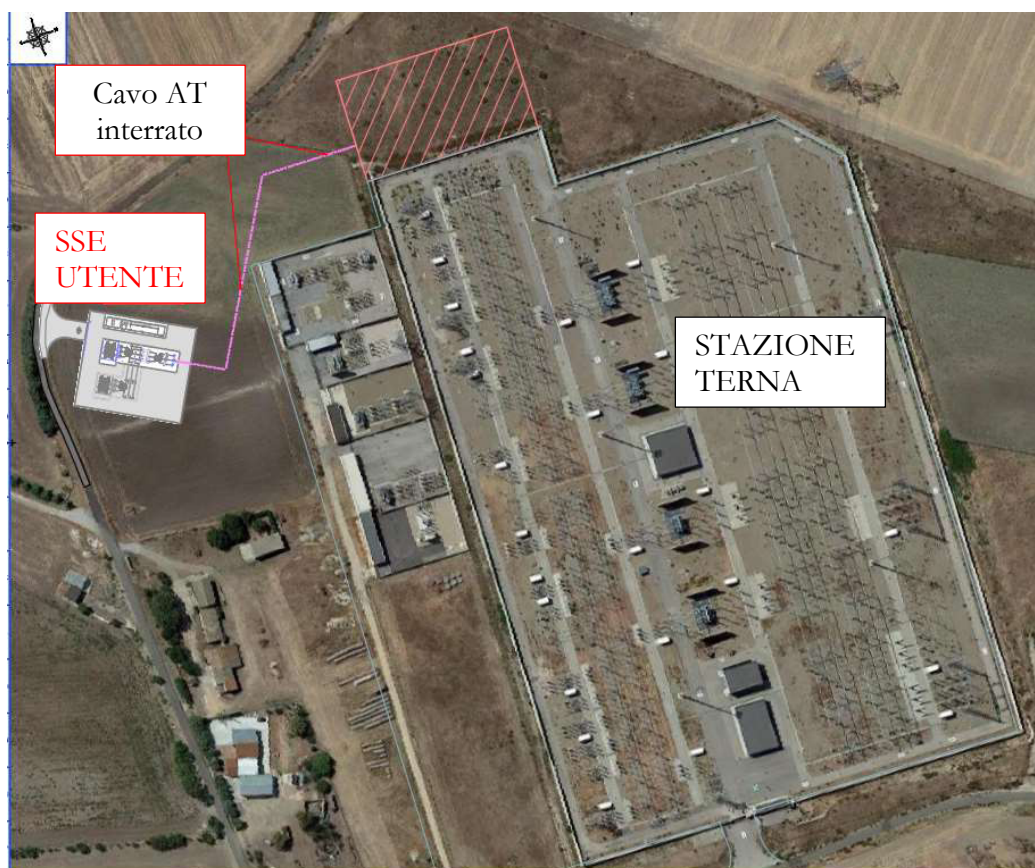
Planimetria con individuazione nuova SSE e elettrodotto di collegamento alla SE Terna esistente
